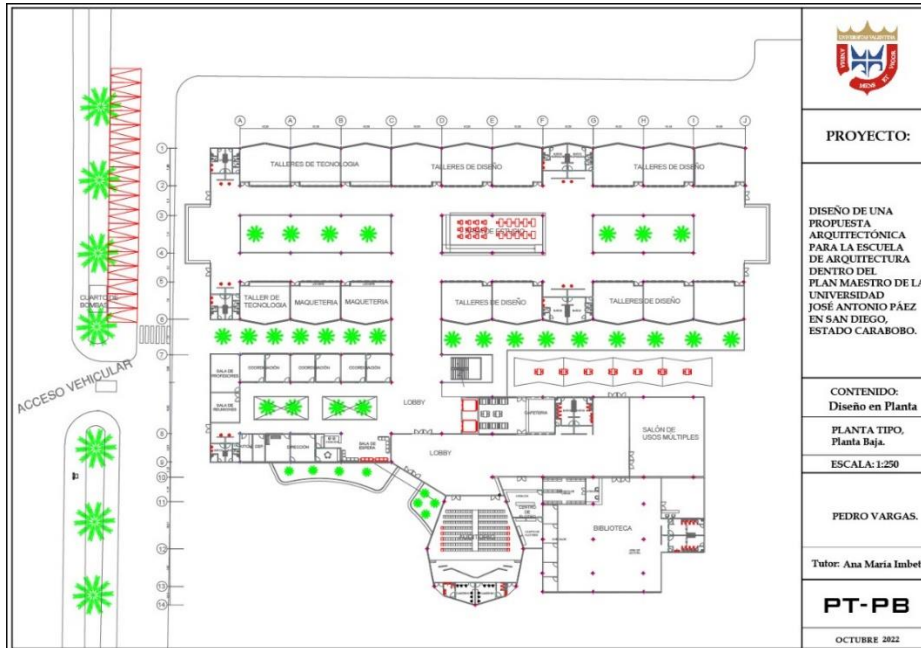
Plano de diseño en vista de planta para Planta Baja.
